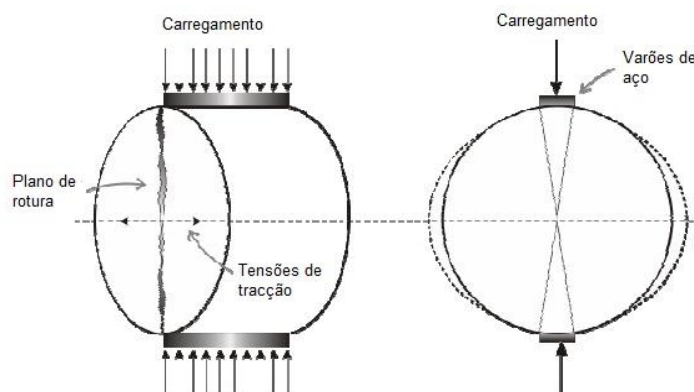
Esquema de carregamento e plano de rotura para o ensaio de compressão diametral (Brito 2006)
